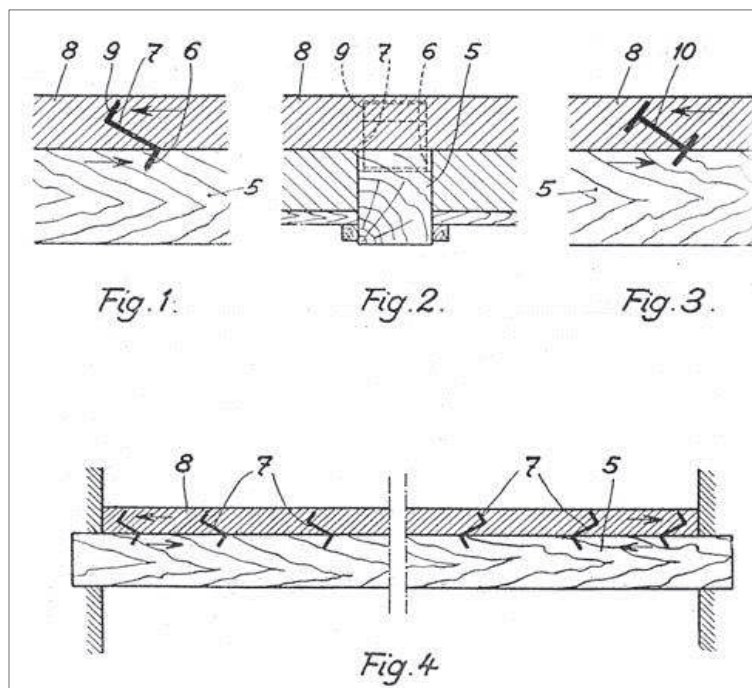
Holz-Beton-Verbunddecke nach SCHAUB aus [6]
